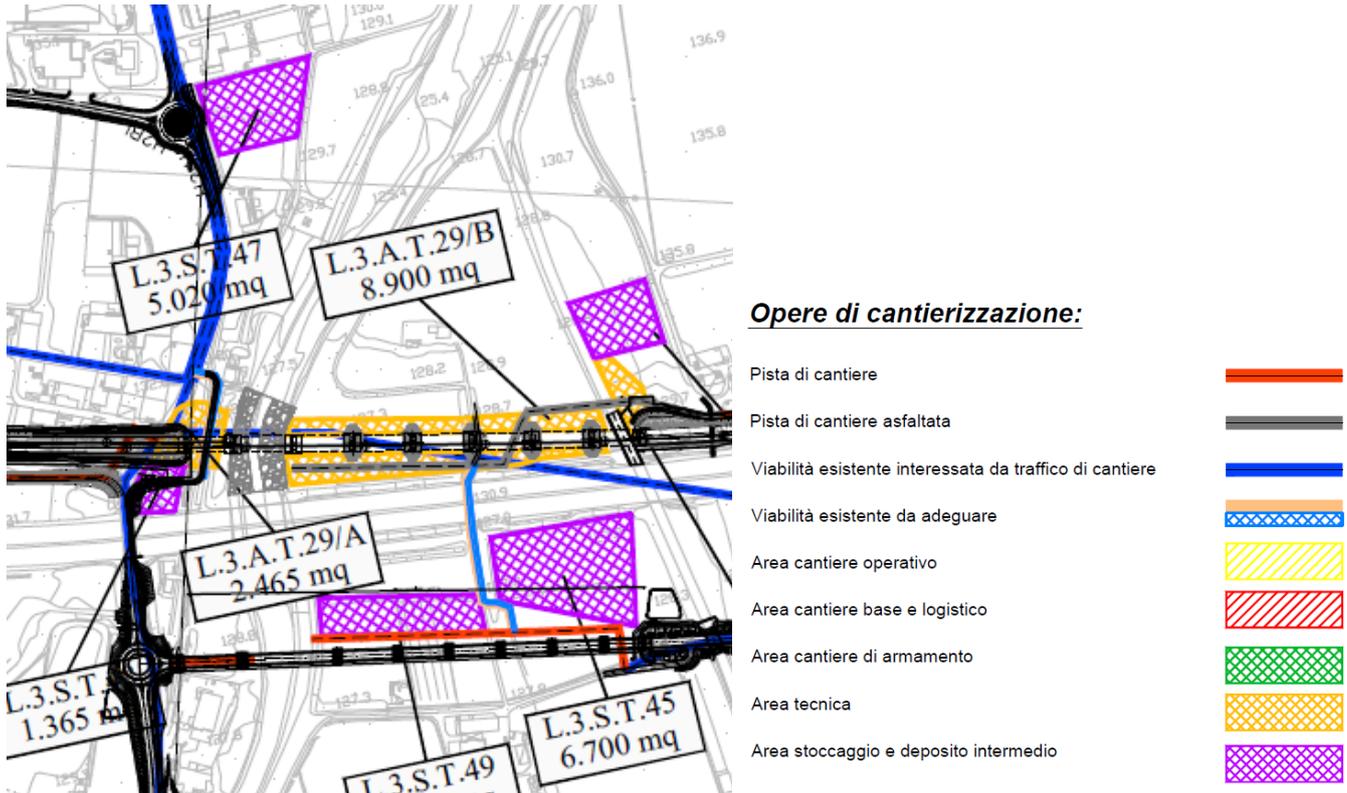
stralcio della planimetria delle aree di cantiere per l'ambito Chiese
